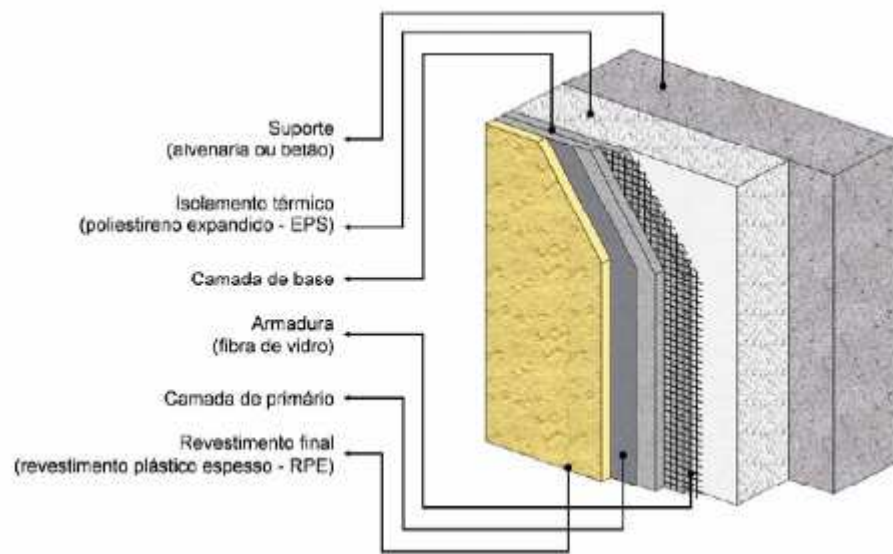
Composição de um ETICS constituído por reboco delgado armado sobre poliestireno expandido (Fonte: Isolamento Térmico de Fachadas pelo Exterior Reboco Delgado Armado sobre Poliestireno Expandido – ETICS)
